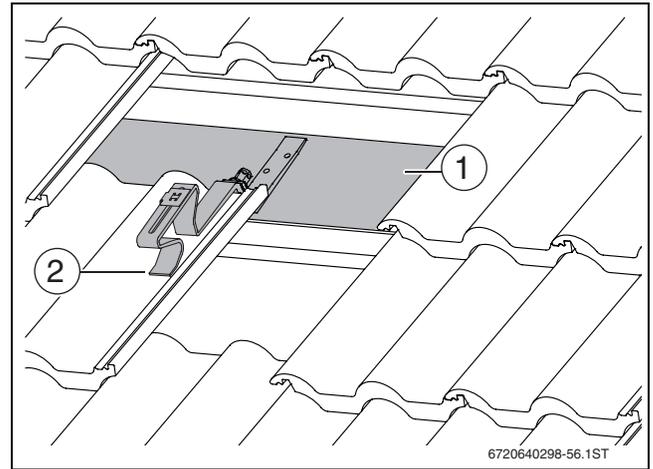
Fissaggio del travetto inclinato su un'asse/una tavola
